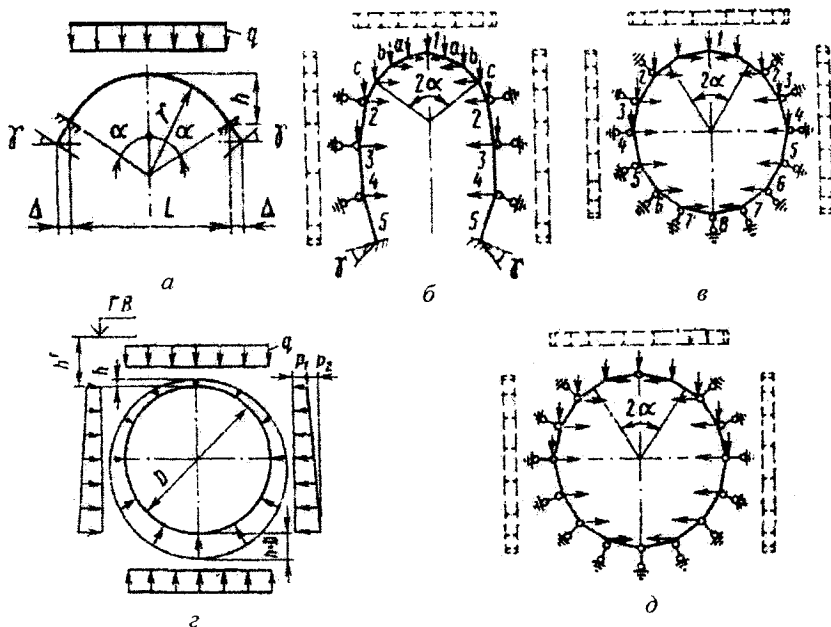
Розрахункові схеми тунельних кріплень: *а* – пологого склепіння; *б* – підйомистого склепіння; *в* – кругового кріплення з чавунних тюбінгів у пружному середовищі; *г* – колового кріплення з чавунних тюбінгів у вільно деформуючому середовищі; *д* – кріплення із залізобетонних блоків
